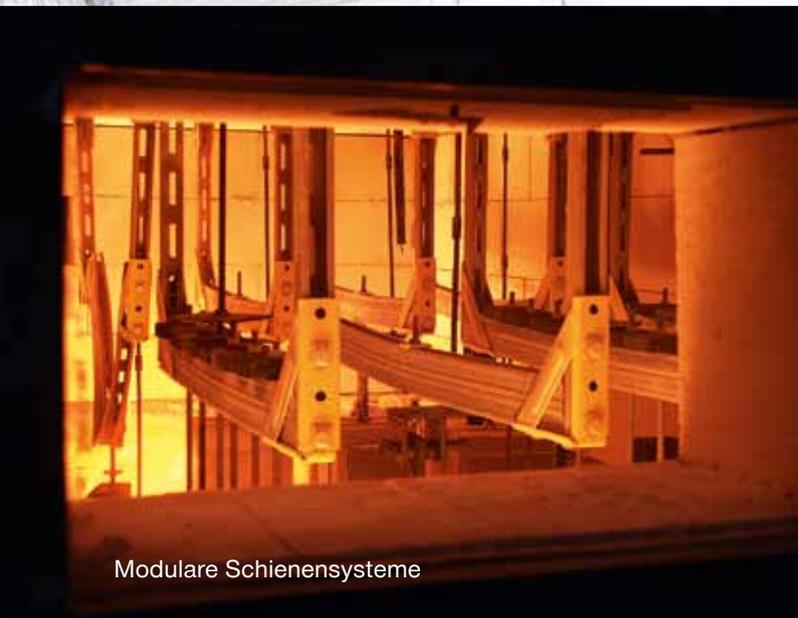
Befestigungsbeispiele für Elektrotrassen
